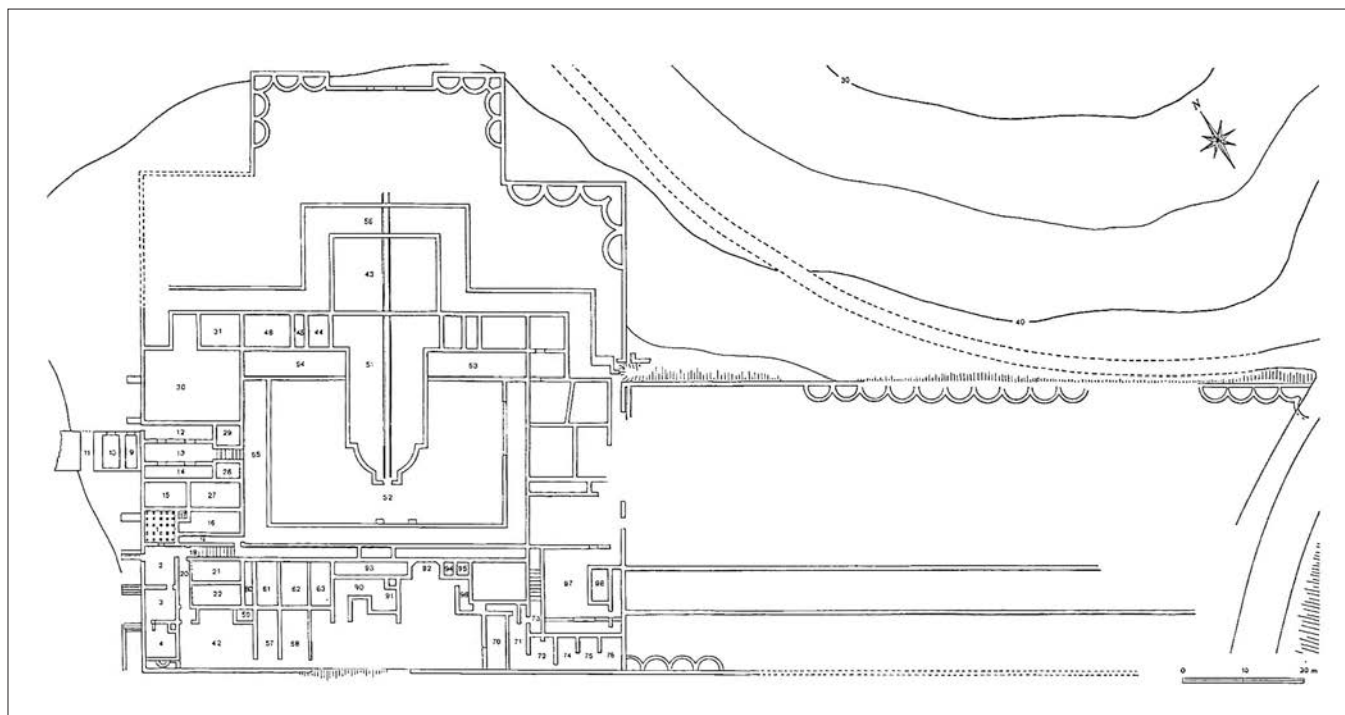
La villa delle Grotte all'isola d'Elba: planimetria generale (da Casaburo 1997, tavola 8).
